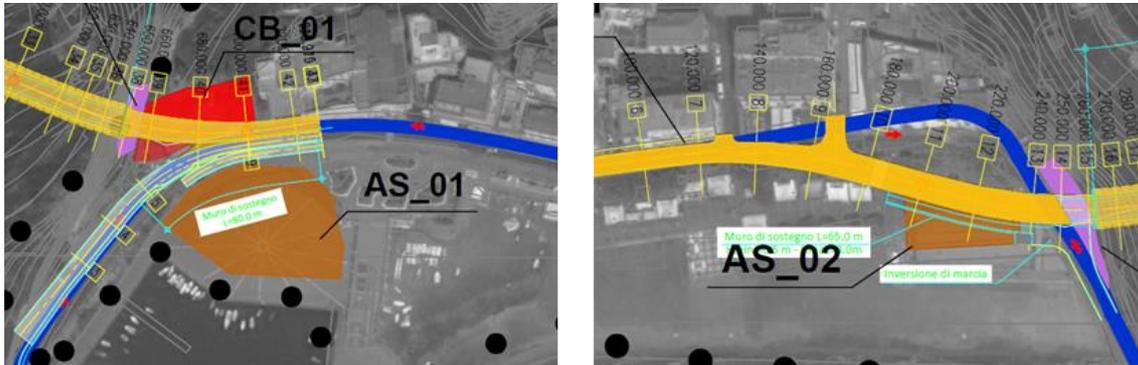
Localizzazione aree di cantiere AS_01 e AS_02
